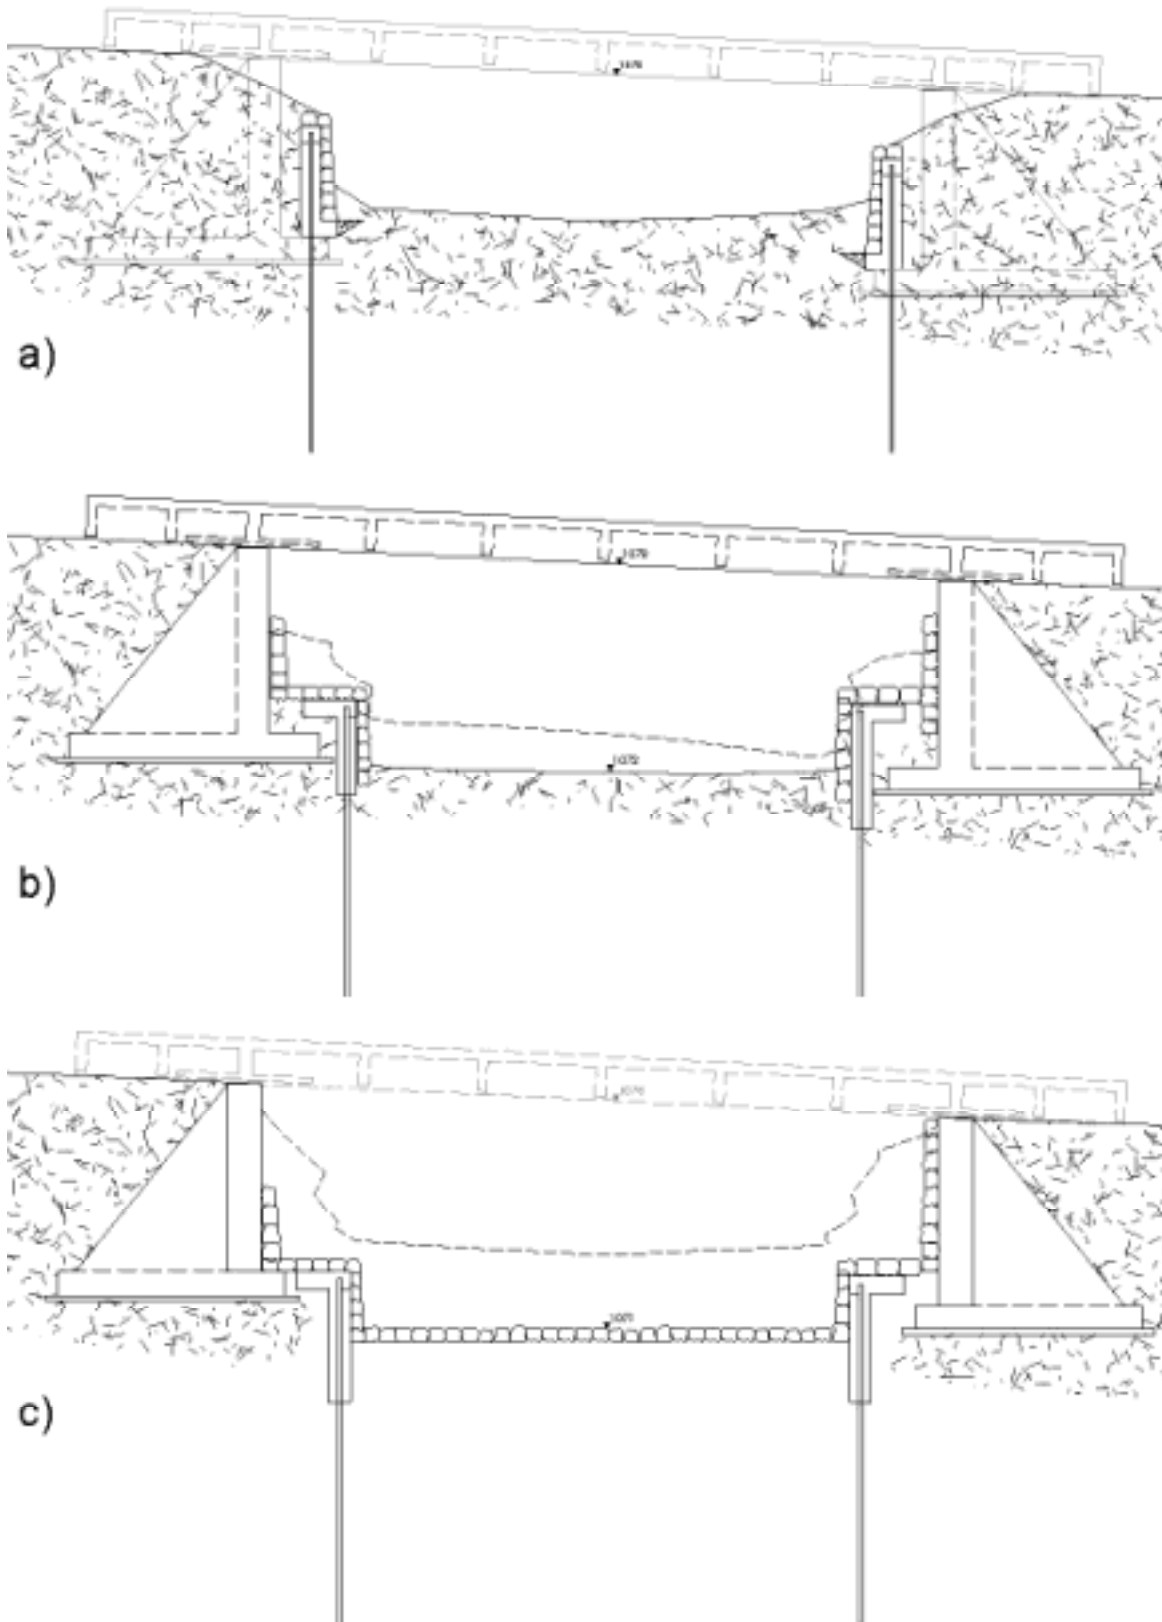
Interventi di consolidamento e protezione delle spalle del ponte: a) sezione di imbocco, b) sezione sotto il ponte, c) sezione di sbocco. Per il raffronto tra le condizioni di progetto e le condizioni attuali si veda la fig. 6.
